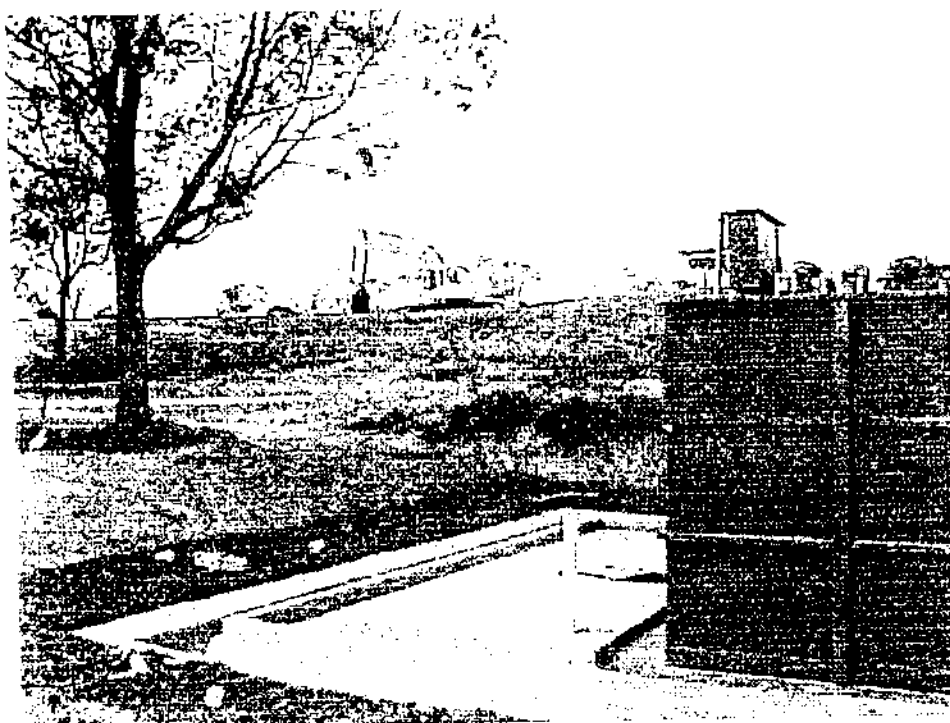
Em primeiro plano, vista da ETE. Ao fundo, escavação do aterro sanitário (detalhe da localização em cota superior a da ETE).
